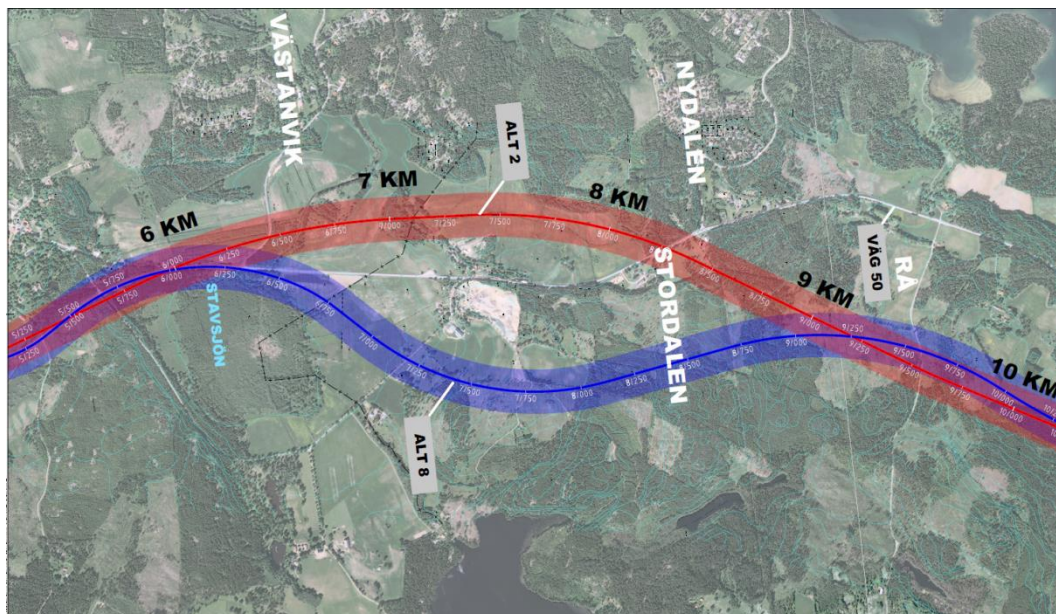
Alternativ 2 och 8 vid Nydalen, km 6-10, plan med ortofoto som bakgrund.
